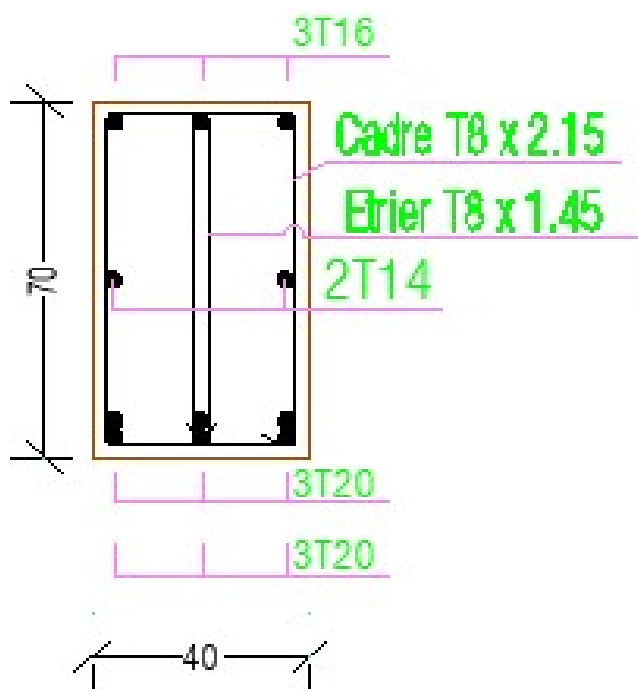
Disposition constructive des armatures des poutres en appui.
